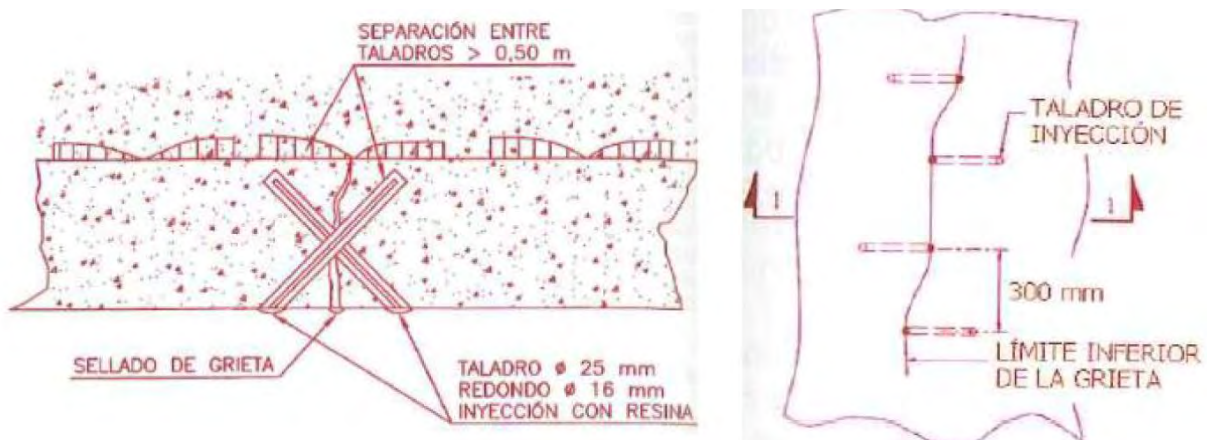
Tratamiento de fisura en elementos de hormigón en masa
